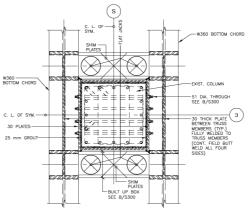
Sistema para aplicación de la precarga a través de gatos hidráulicos (2 por lado): Puntal con ménsulas y viga de transferencia conectada al cordón inferior de los reticulados. Esquema – corte transversal.
